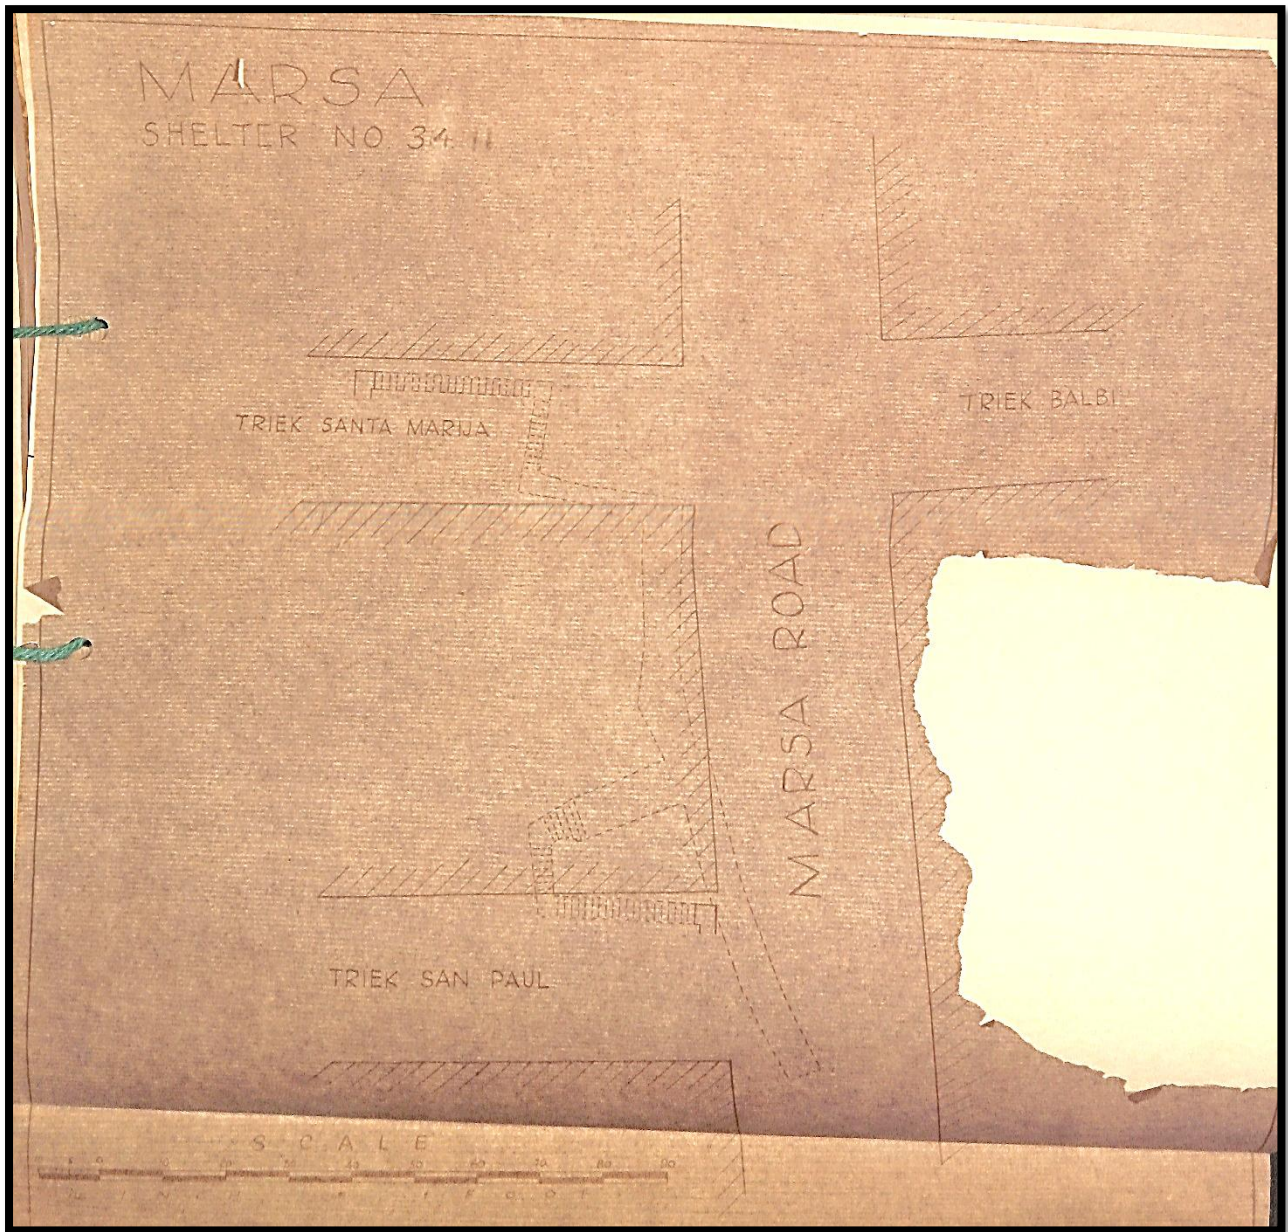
Planta do Abrigo nº34 (11) "Triek Marua – Triek Balbi – Triek San Paul – Marsa Road."
